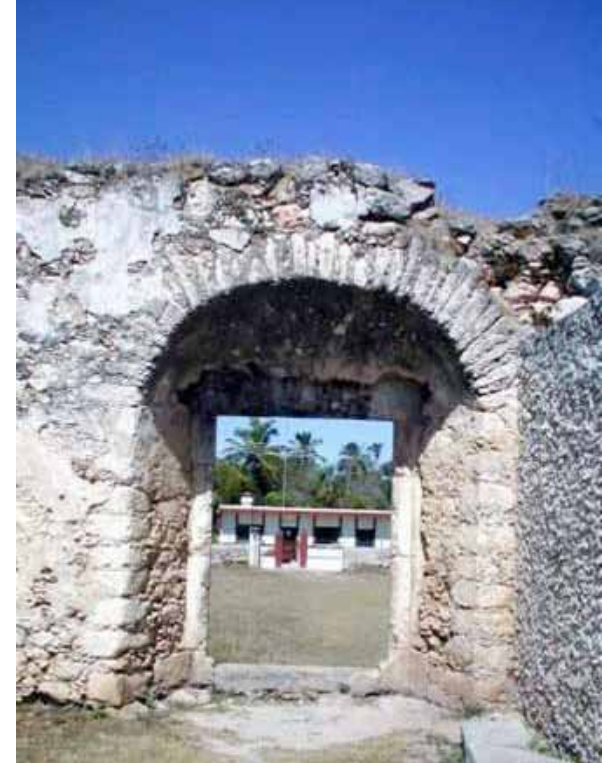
Capialzado de piedras laja en la Capilla de San Antonio en Ucí,, Yucatán. Fuente: A. Román.
